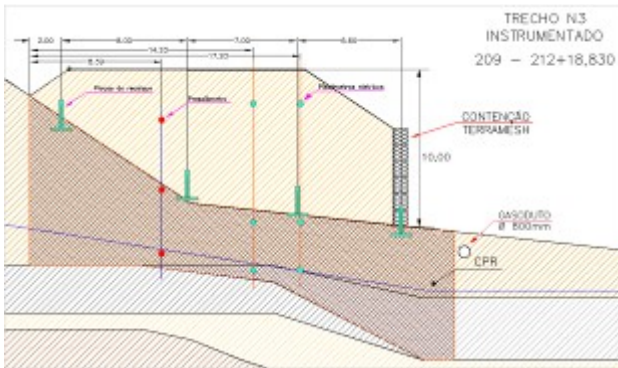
Projeto, em corte, da rodovia marginal, destacando-se o muro da construção, o gasoduto abaixo e o solo de fundação tratado com CPR.
